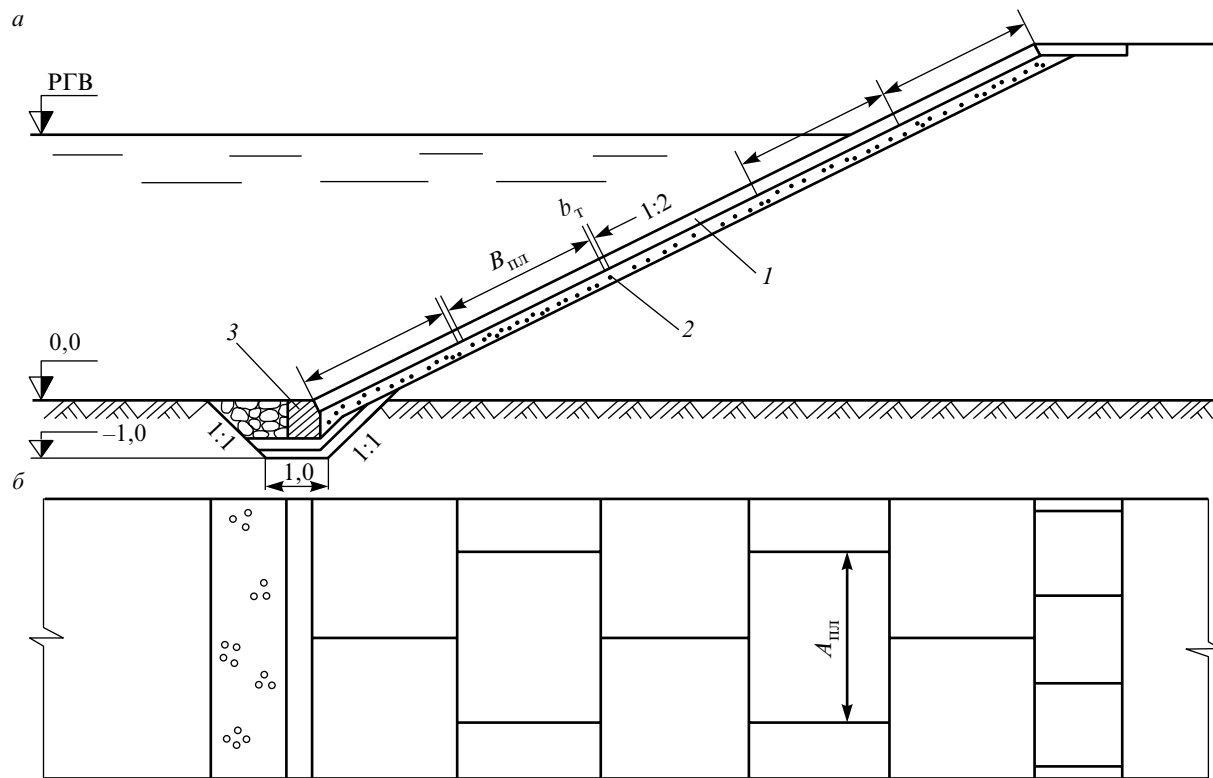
Укрепление откоса покрытием из железобетонных плит:
